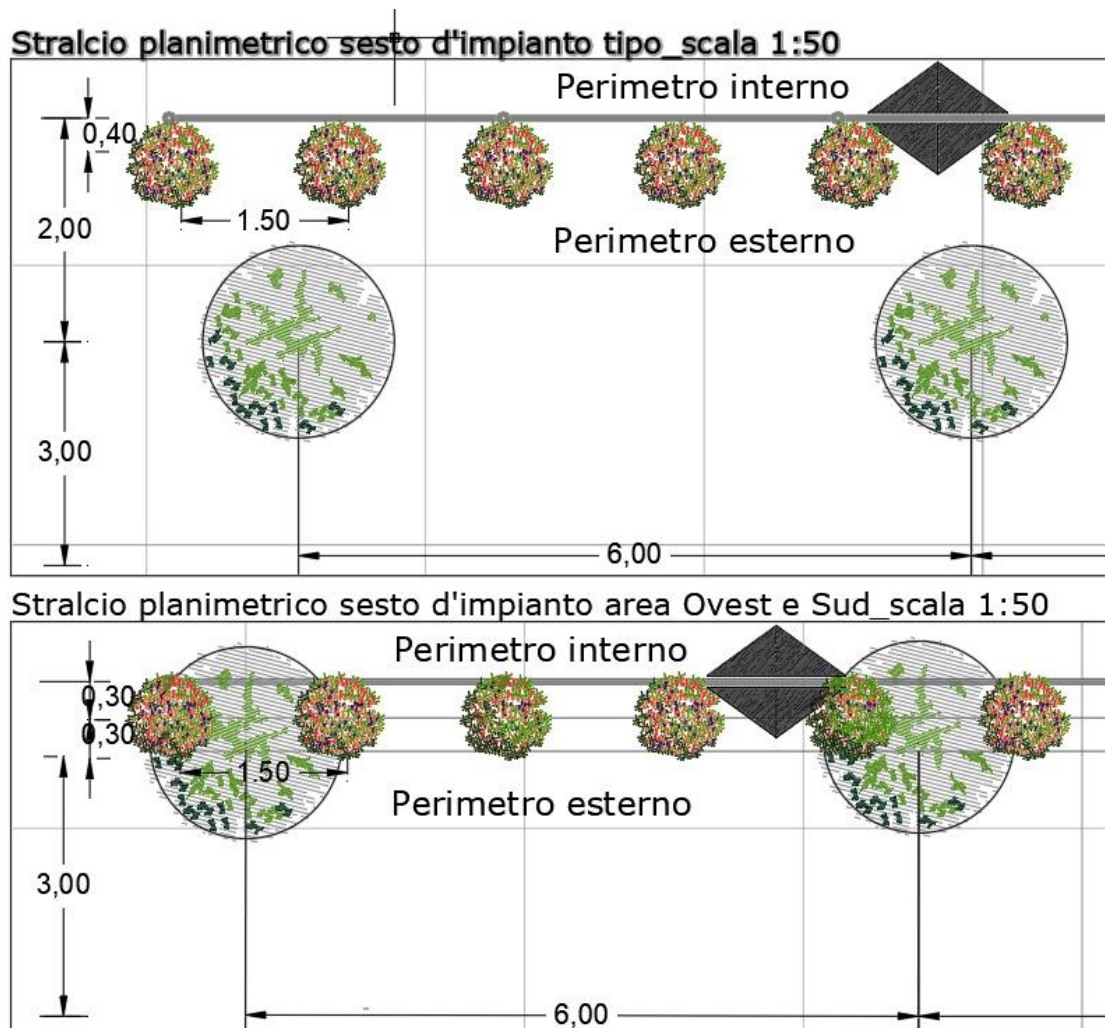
Stralcio planimetrico del sesto d'impianto della mitigazione
